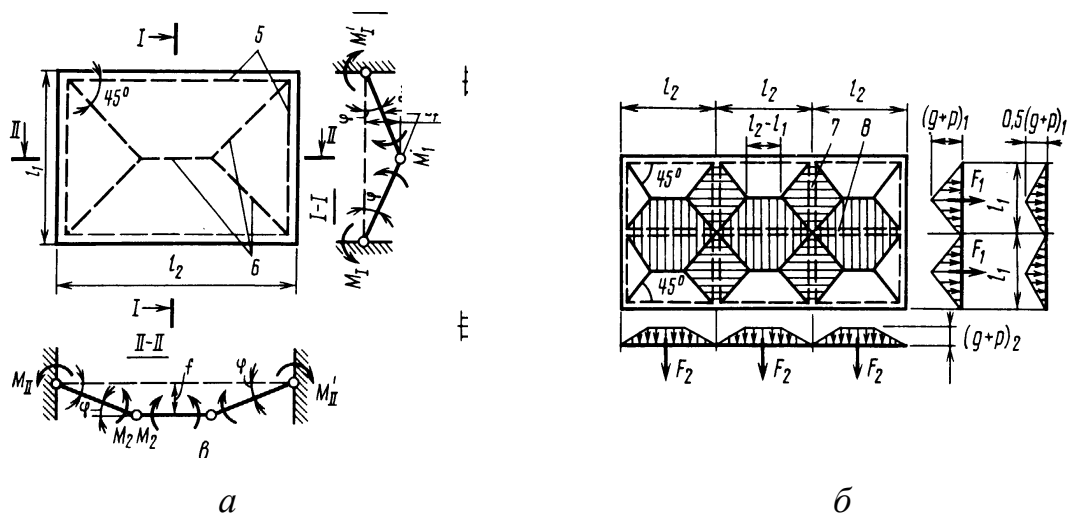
Розрахункова схема плити, опертої по контуру,
